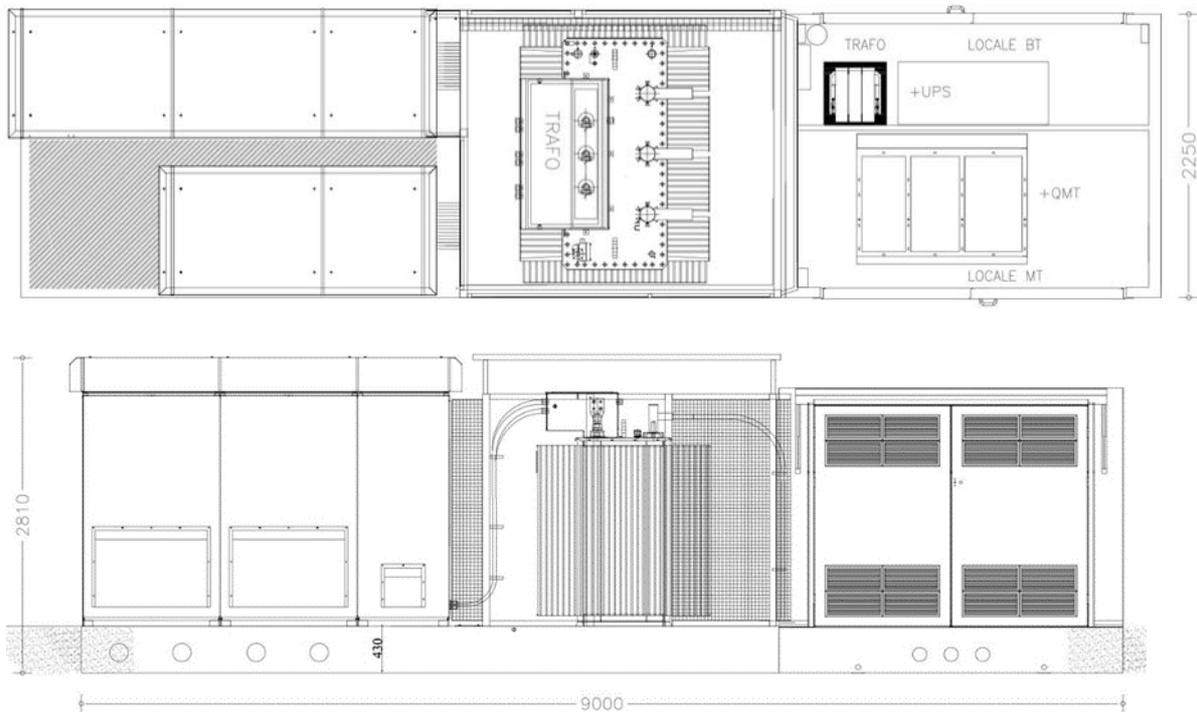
Pianta e Prospetto del gruppo di conversione e trasformazione.
